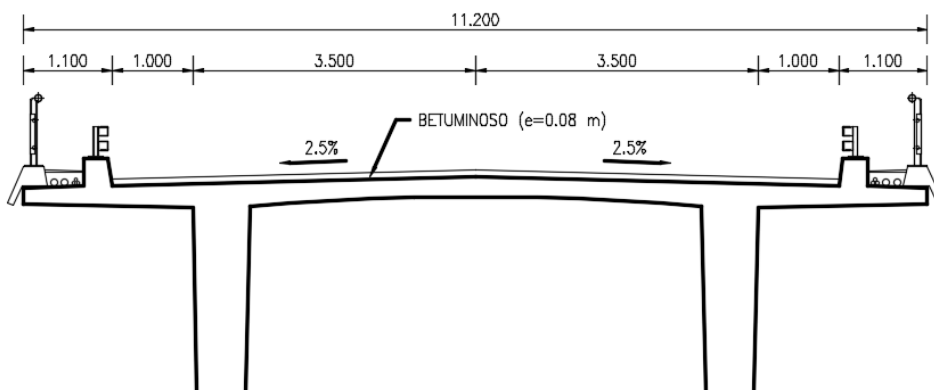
Perfil transversal do viaduto - secção corrente.
